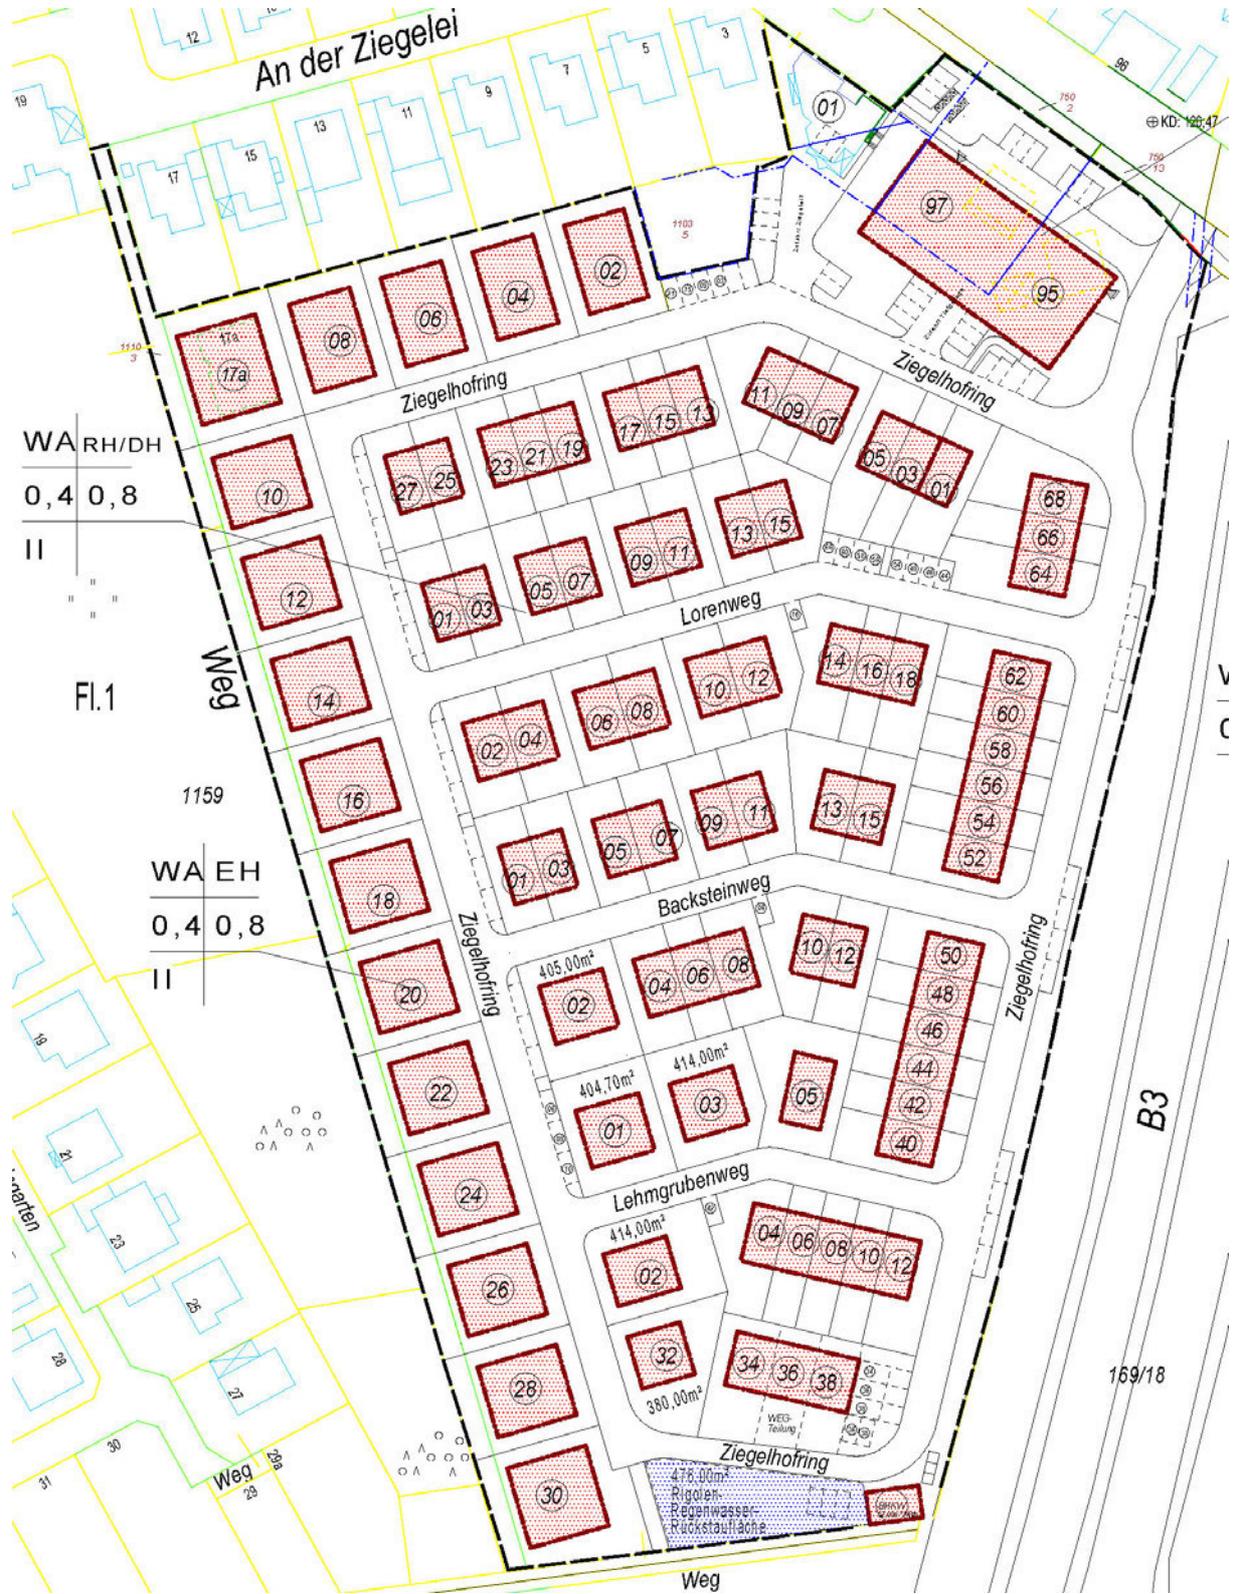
städtebaulicher Entwurf zur aktuellen Bebauungsplanänderung (Quelle: Serio, Planungsbüro für Bauwesen, Bad Vilbel)
